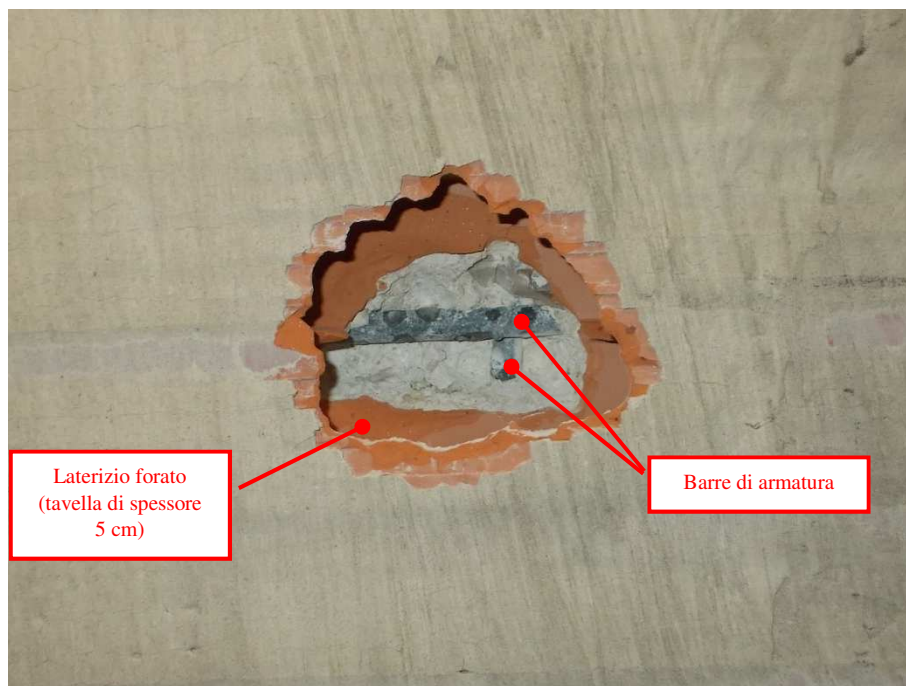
Piano Terra. Architrave in c.a. con tratto di appoggio di circa 30 cm.
